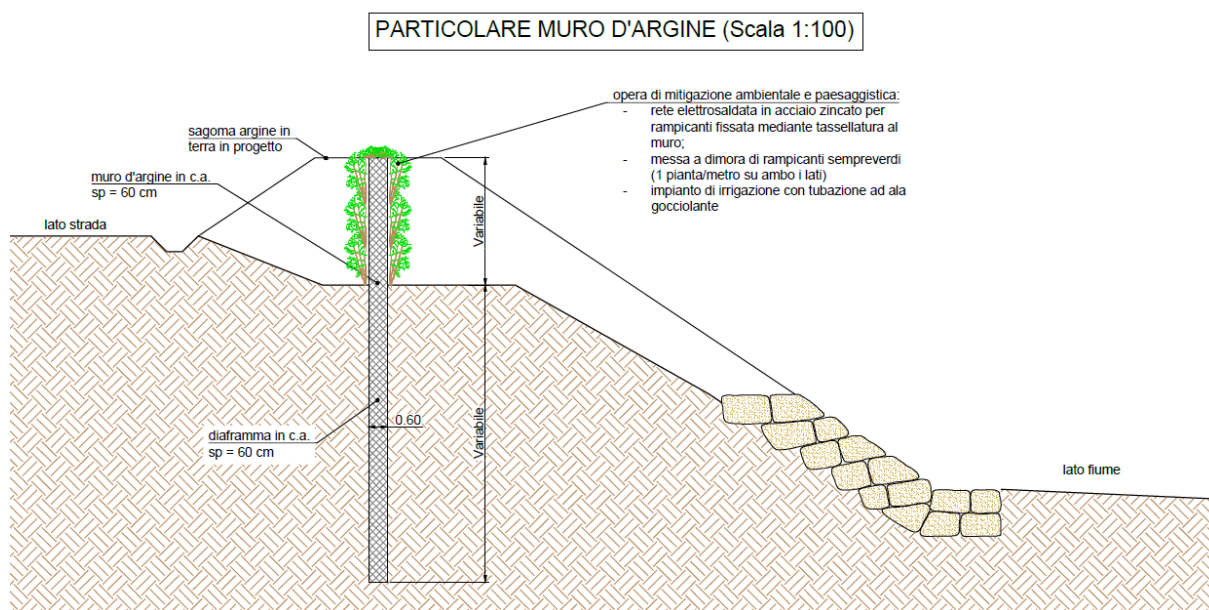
Particolare muro d'argine su diaframma in c.a.
